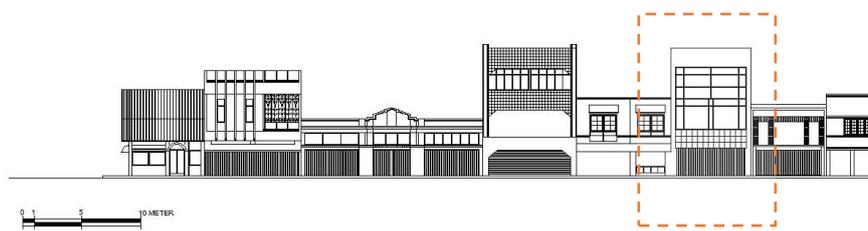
Aplikasi warna fasade pada bangunan Jalan Braga
